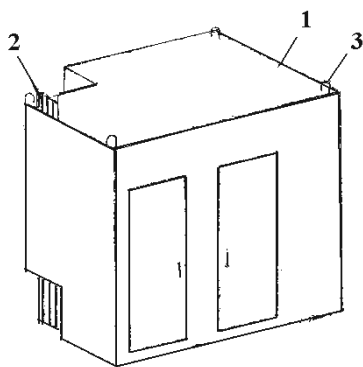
Об'ємно-просторова санітарно-технічна кабіна: 1 – залізобетонна кабіна; 2 – трубопроводи; 3 – монтажні петлі
